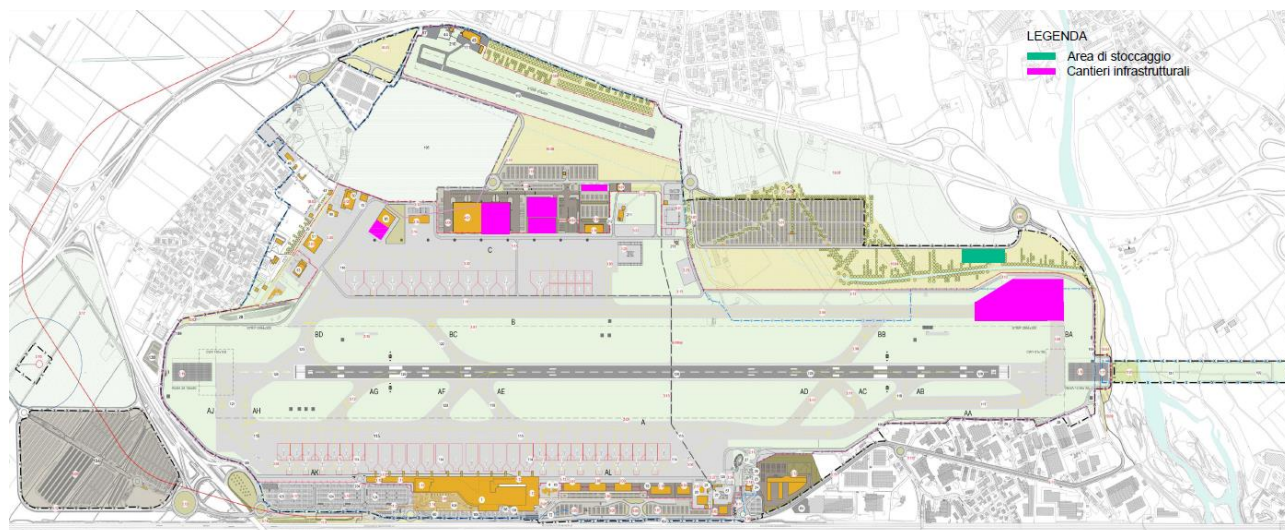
Layout cantieri infrastrutturali (in viola) e area di stoccaggio (in verde)
